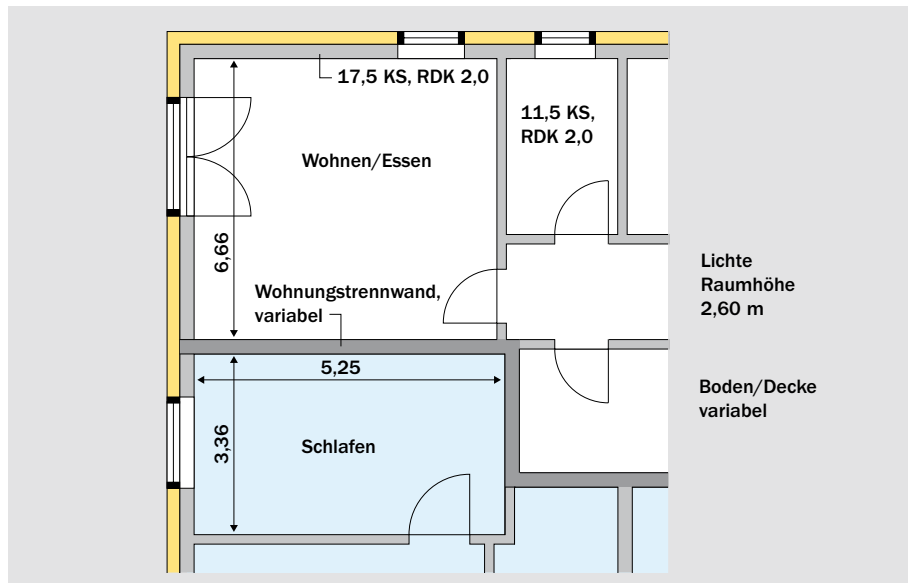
Ausschnitt Grundriss eines Mehrfamilien-Wohnhauses
